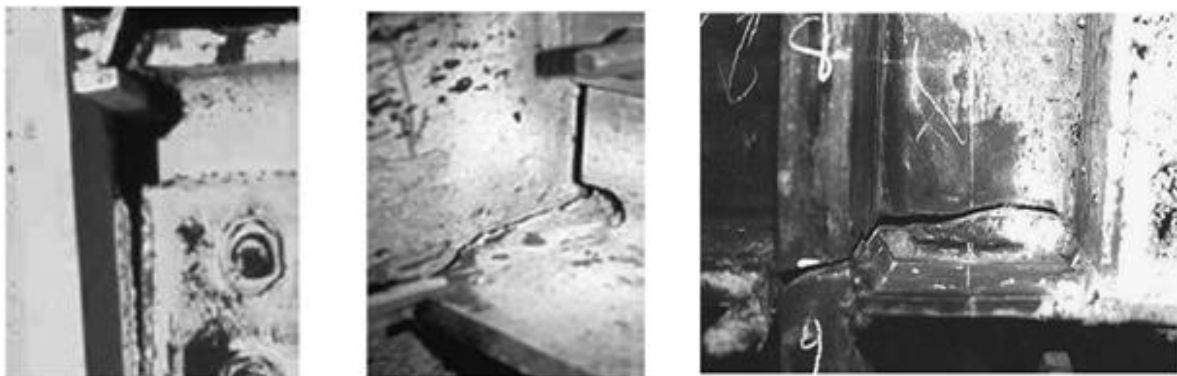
Fallas en las conexiones viga-columna de las estructuras de acero en Northridge. Fuente: [3]
